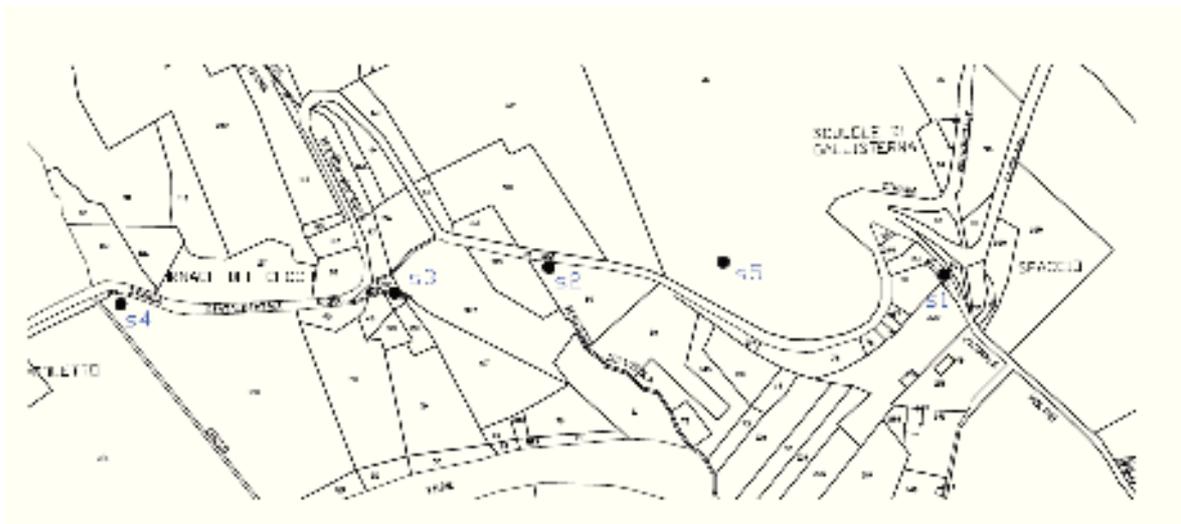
Planimetria area di progetto ed ubicazione dei sondaggi
